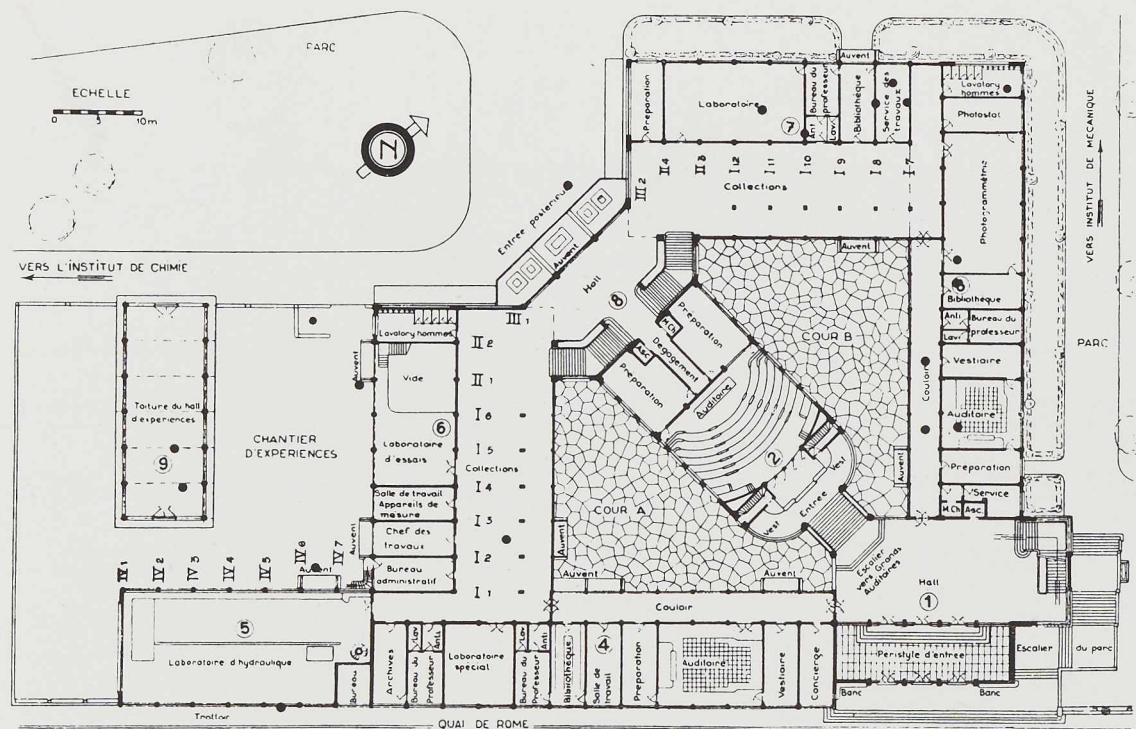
Plan d'ensemble des instituts universitaires du Val-Benoît (Liège).
